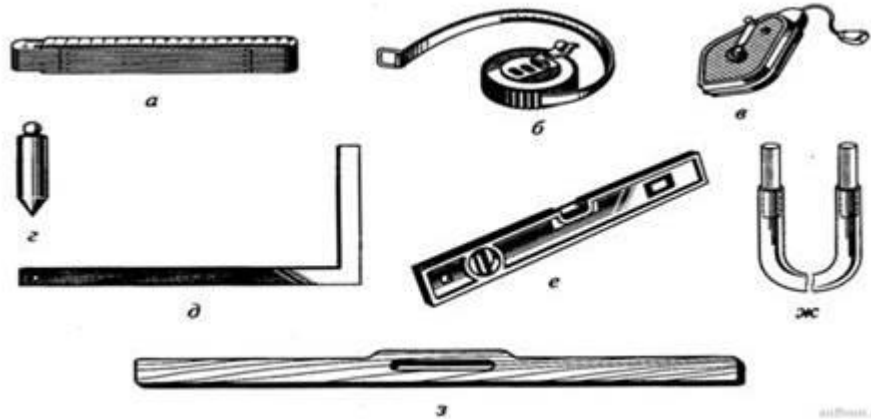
Інструменти для вимірювання та перевірки поверхонь, що обробляються: а – метр складний; б – рулетка; в – розмічальний шнур; г – висок; д – кутник; е – будівельний рівень; ж – водяний рівень; ж – рейка-правило
